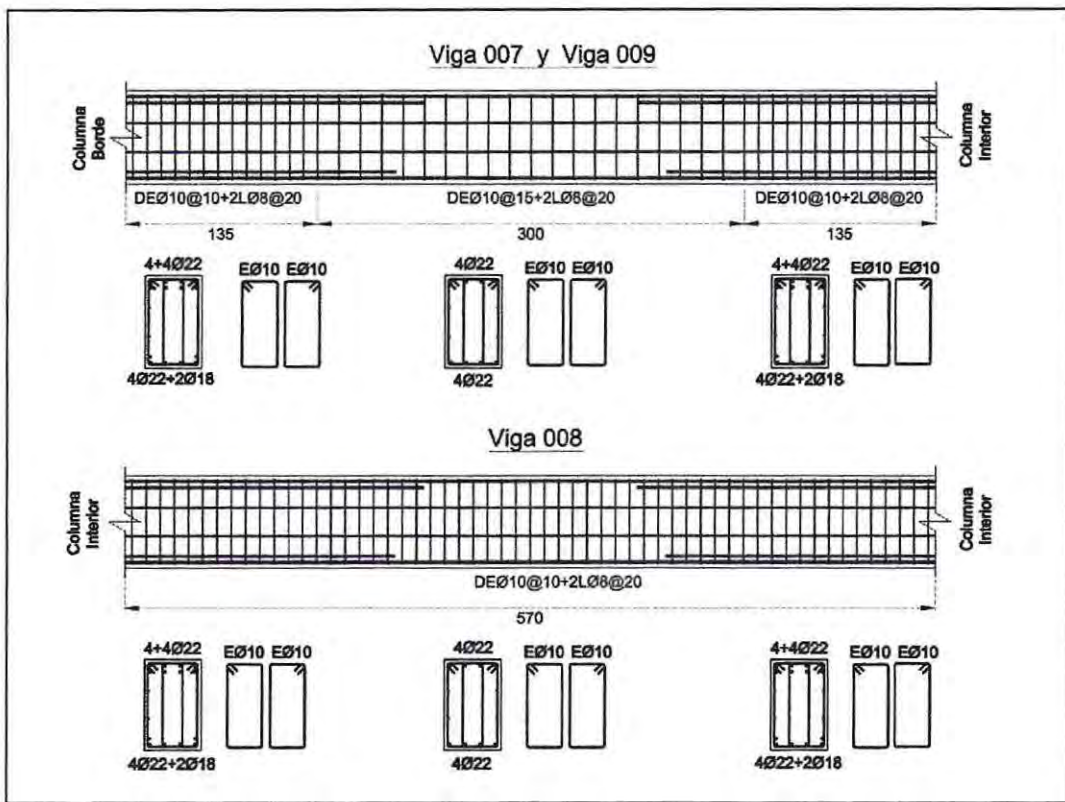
Distribución armadura de corte en vigas Eje 2, estructura con marcos.
